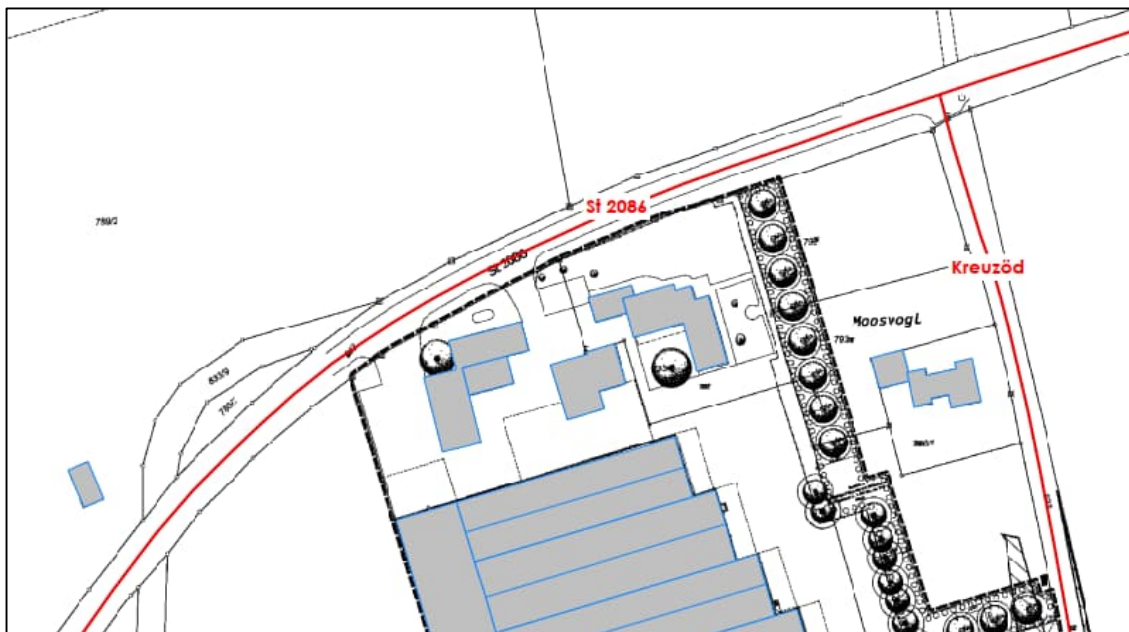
Lageplan mit Darstellung der relevanten Schallquellen zur Ermittlung der anlagenbezogenen Verkehrsgläusche auf öffentlichen Straßen
